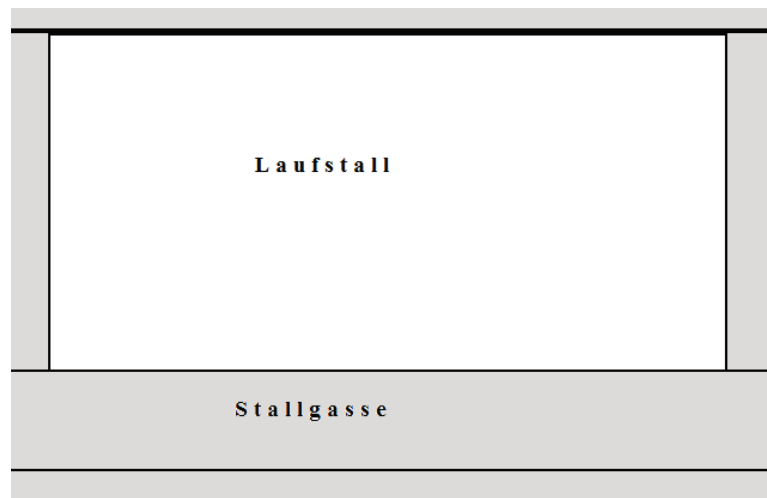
Grundriss eines Einraum-Gruppenlaufstalls
